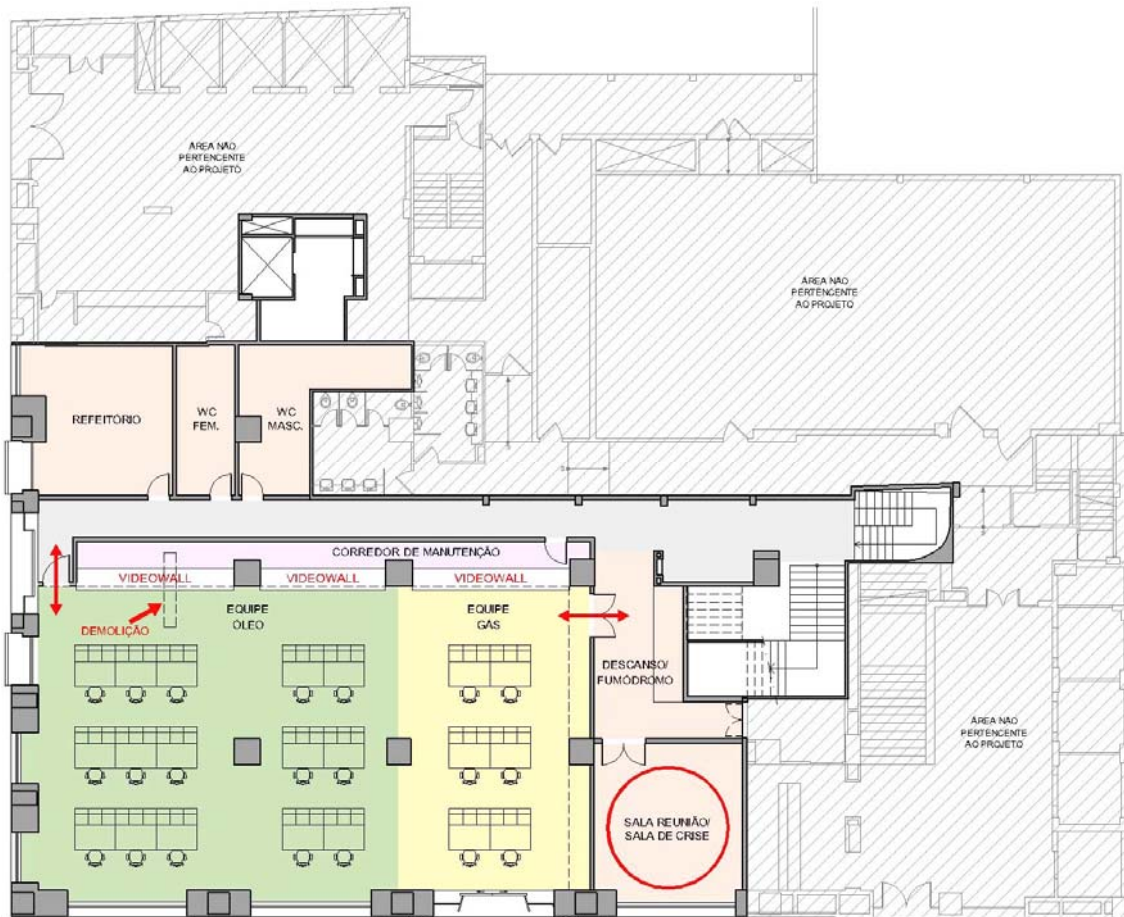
Planta baixa pavimento térreo: opção 2 para o layout (oito de junho)
